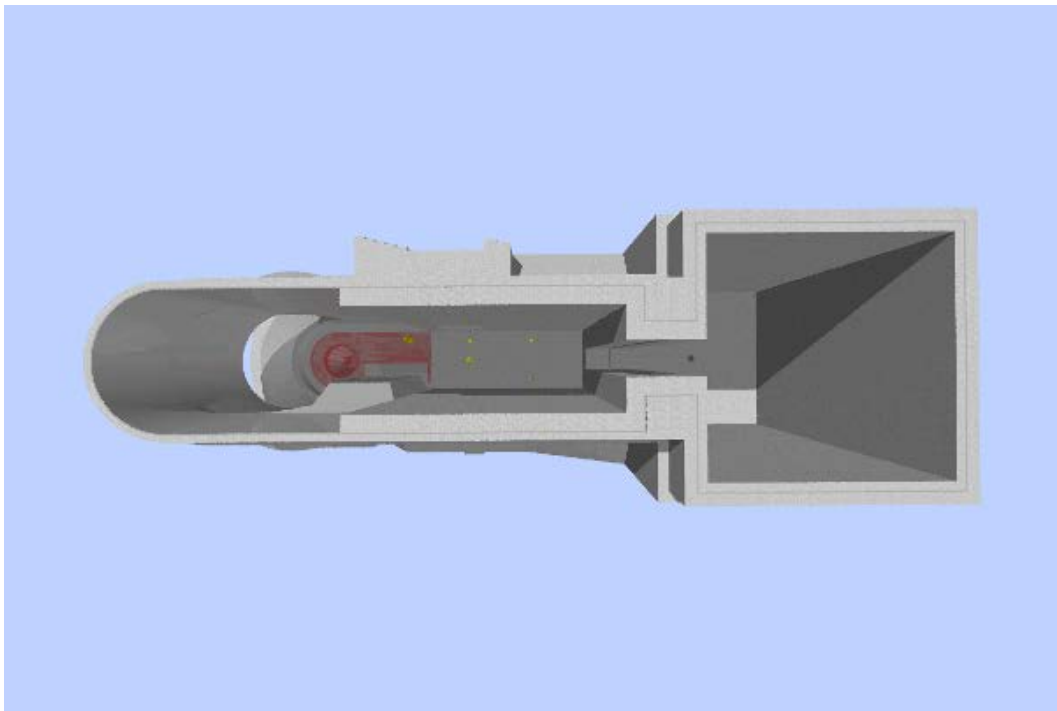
Beispiel für Abbau Boden Becken I
